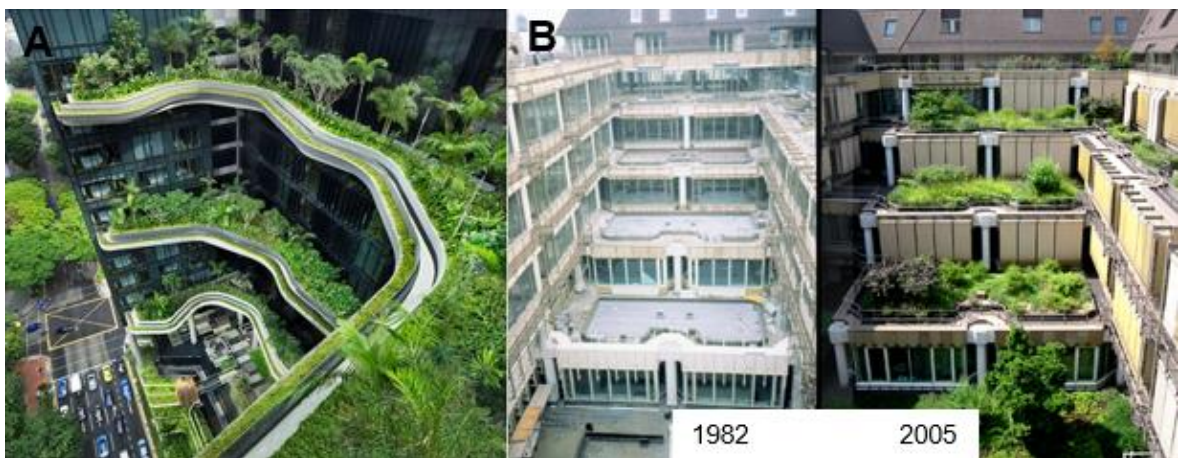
Telhados verdes em pavimentos escalonados. A- Parkroval Hotel na Cidade-Estado de Singapura. B – Edifício da Allianz Seguros em Stuttgart em 1982 e após implantação de telhados verdes em 2005 (Adaptado de BREUNING JÖRG & GREEN ROOF SERVICE LCC, 2016).
